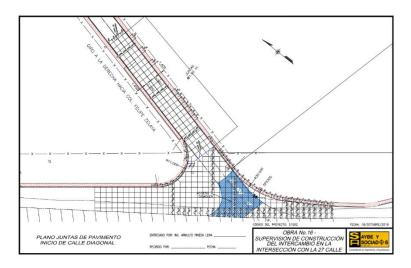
Plano de juntas de pavimento proyecto intersección 27 calle.
